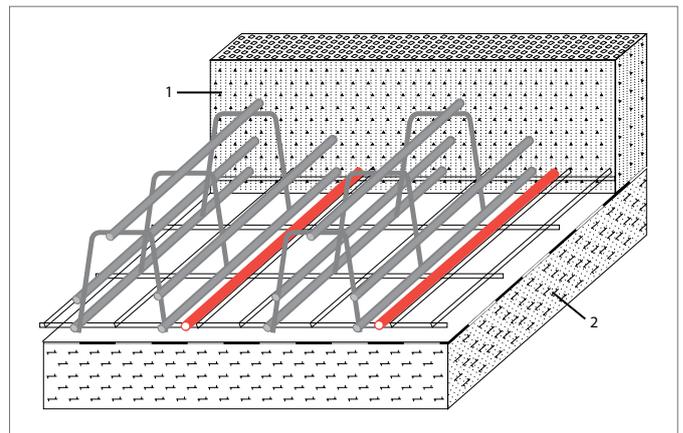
Mit Stahlmatten bewehrte Bodenplatte; Standardkonstruktion Heizungsrohre auf der unteren Bewehrungsmatte montiert
